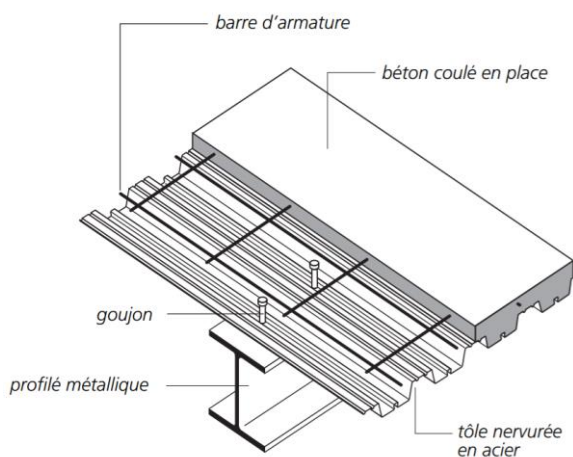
Exemple de plancher à tôle profilée collaborant.
